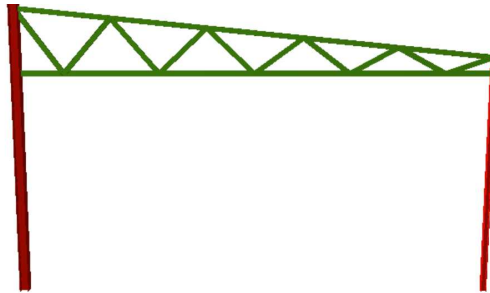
Esquema estructural de la sección longitudinal del edificio auxiliar del proyecto.
